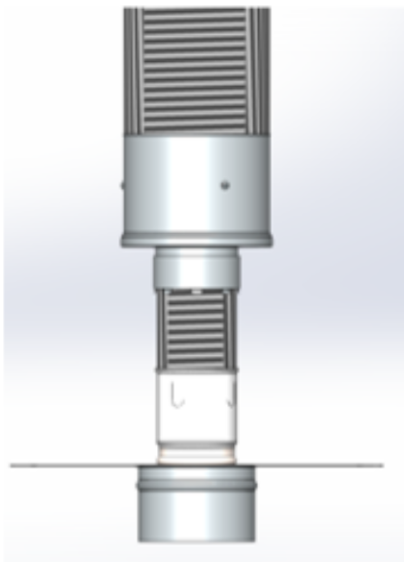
conduit flexible isolé POLYPERF équipé de la pièce d'adaptation haute
